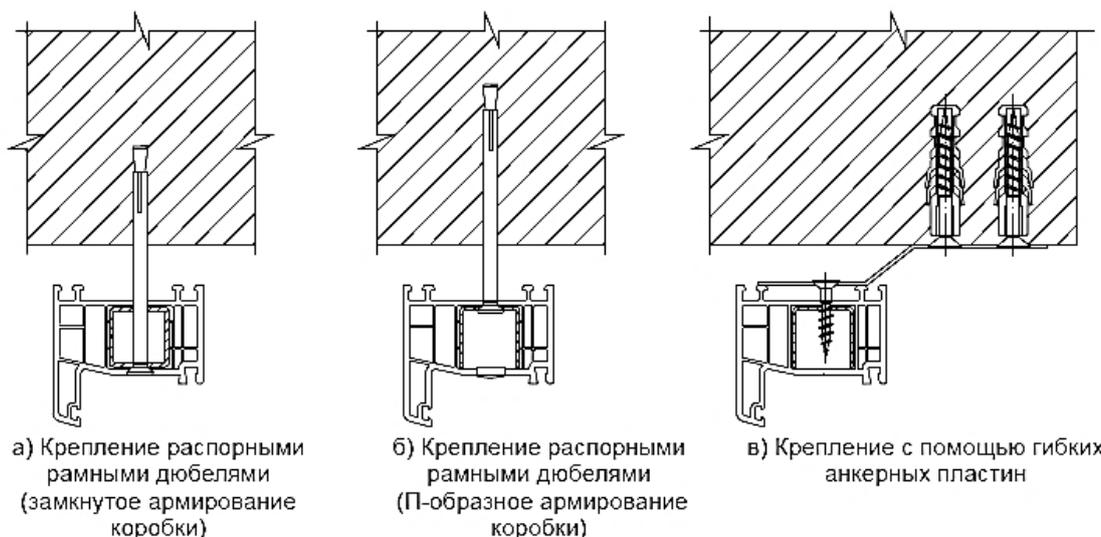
Схемы крепления оконных блоков к стене
